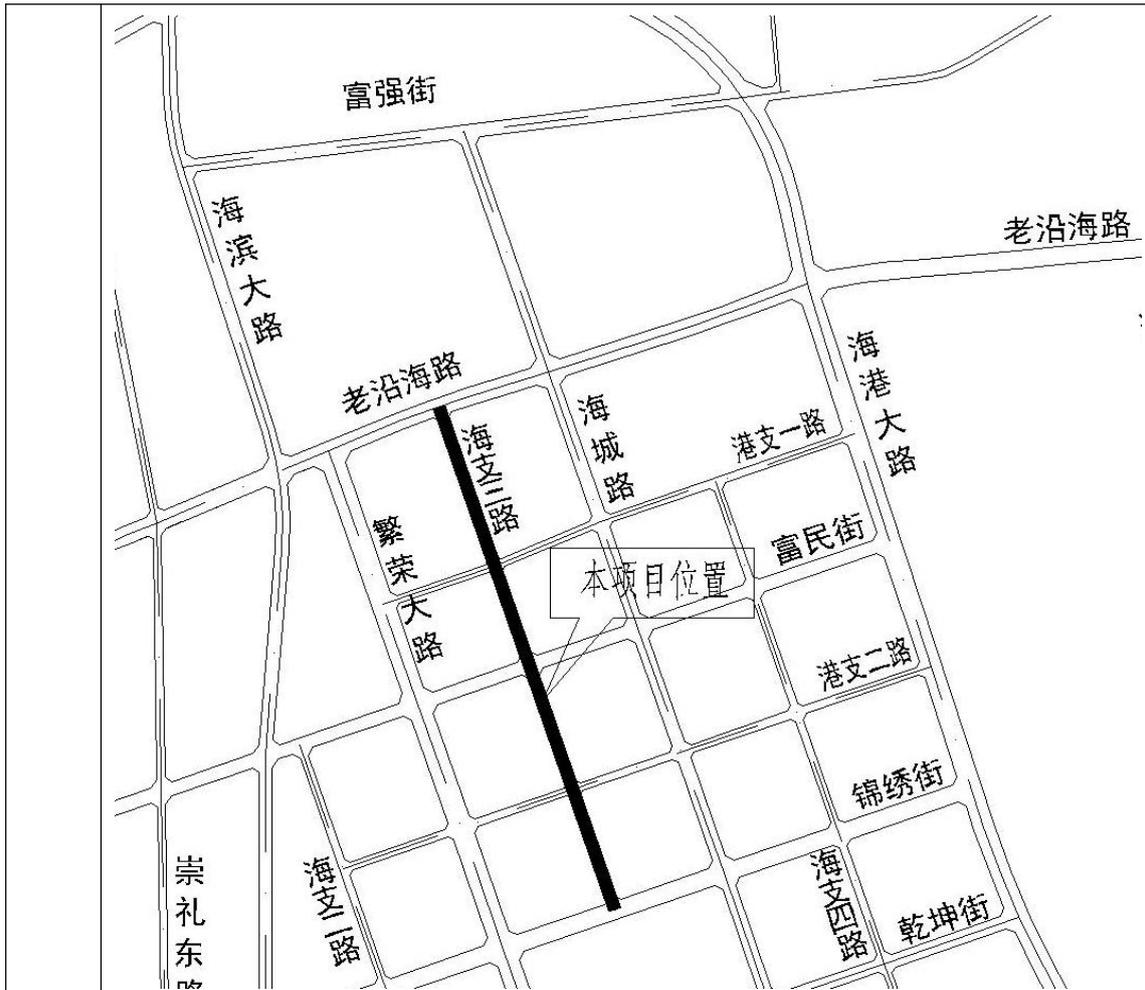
海支三路（锦绣街-老沿海路）道路平面图
